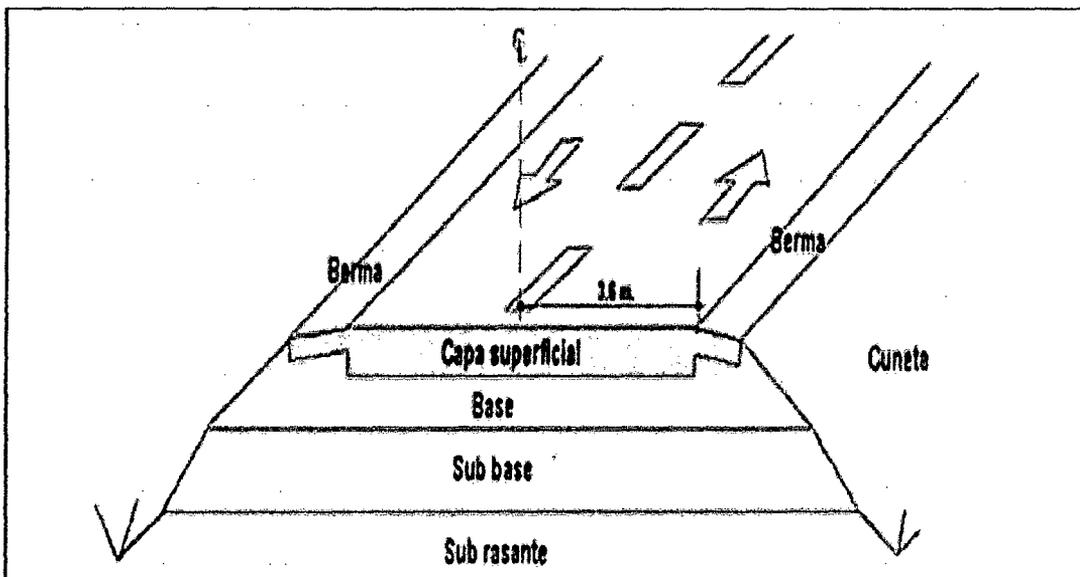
Estructura típica de un pavimento asfáltico (flexible).
